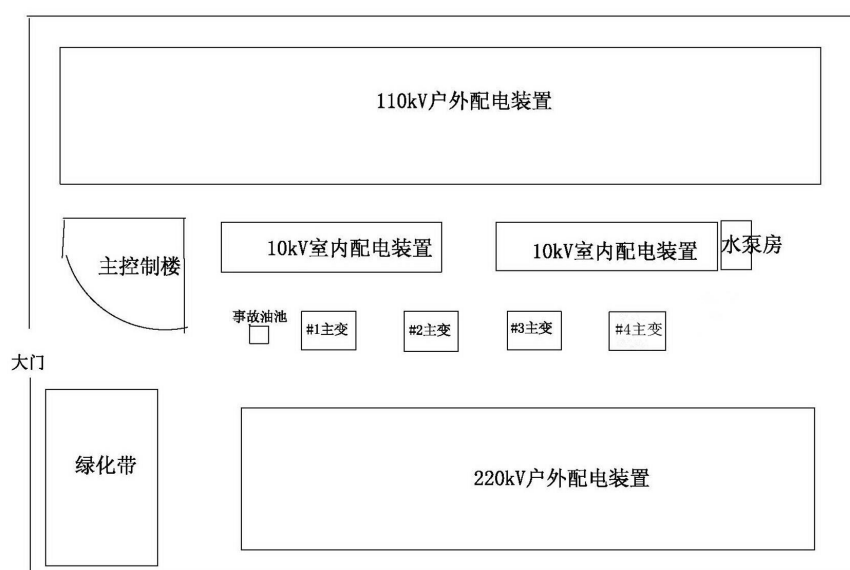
东莞 220kV 白玉站总平面图布置示意图
